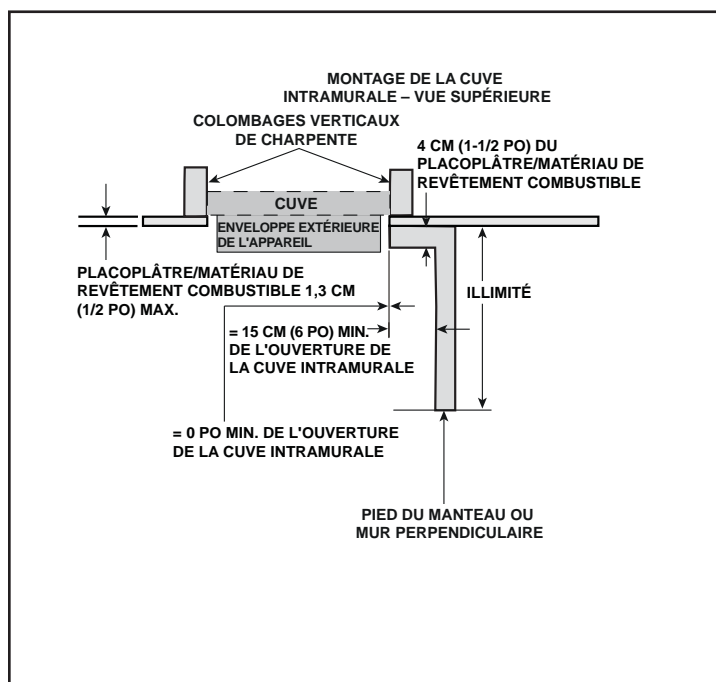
Pied du manteau de foyer ou saillie du mur non combustibles (acceptable de part et d'autre de l'ouverture)
